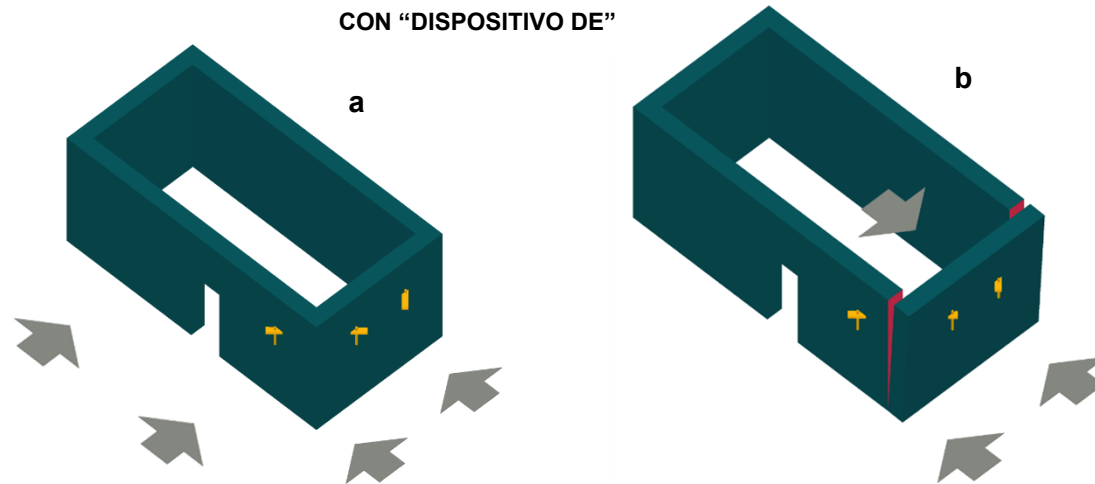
a) Estructura antes del sismo; b) Estructura posterior al sismo con daños en y fuera del plano de muro, dispositivo DE. Fuente: Elaboración propia
